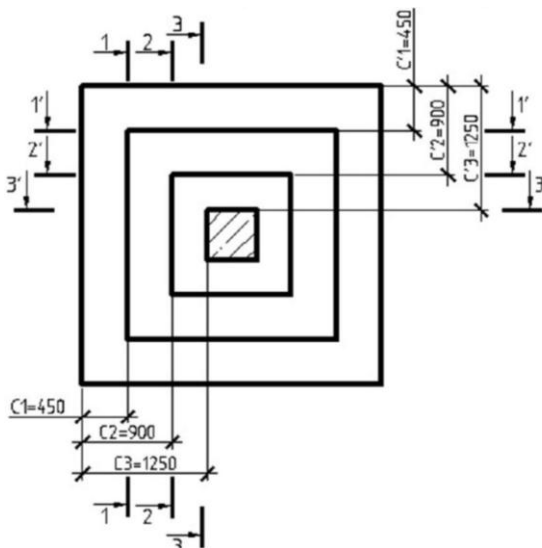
Схема розрахунку арматури плитної частини фундаменту
